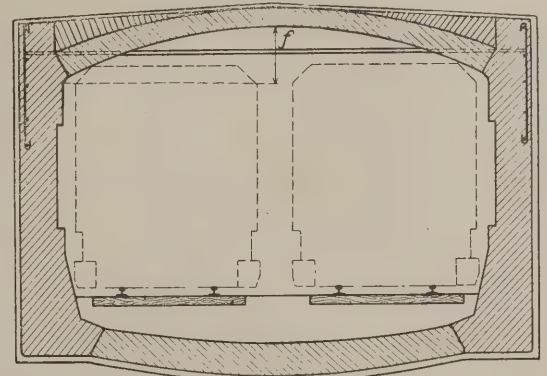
a. Vorgeschlagener Querschnitt für normale Tunnelstrecken (mit unvollständiger Bewehrung).
